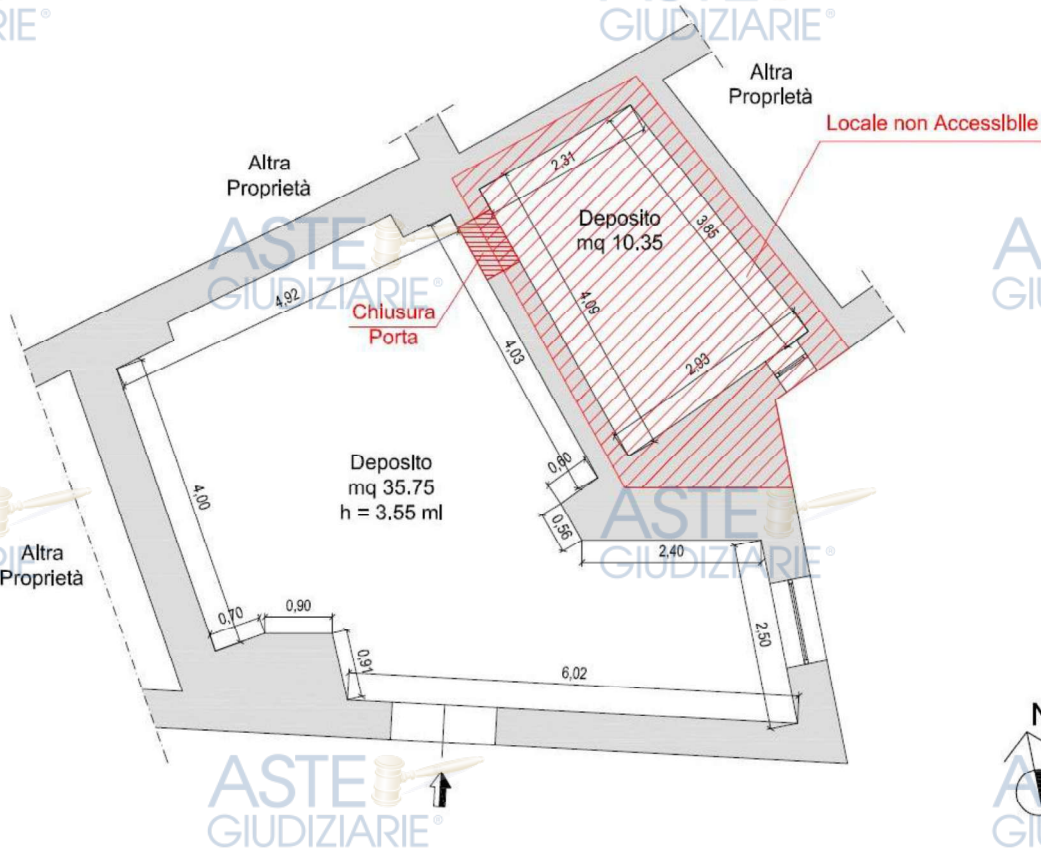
Planimetria Stato di Fatto Piano Terra, Foglio 20, p.lla 124, Sub 14 (Graffata con p.lla 130, sub 5).
